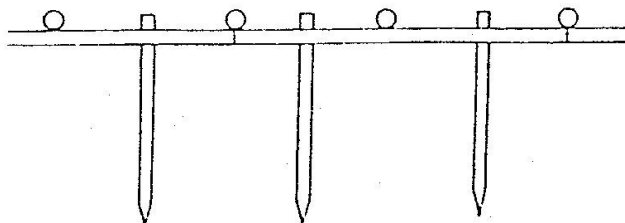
Vista dall'alto degli ancoraggi nel terreno.
